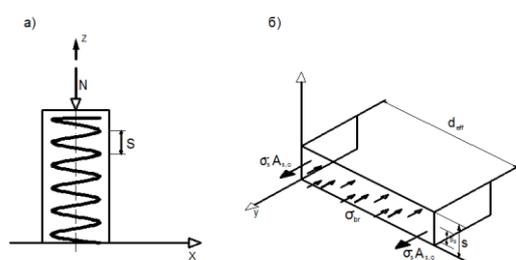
Железобетонный элемент со спиральным армированием: а – вид сбоку; б – схема усилий в рассматриваемом фрагменте.
